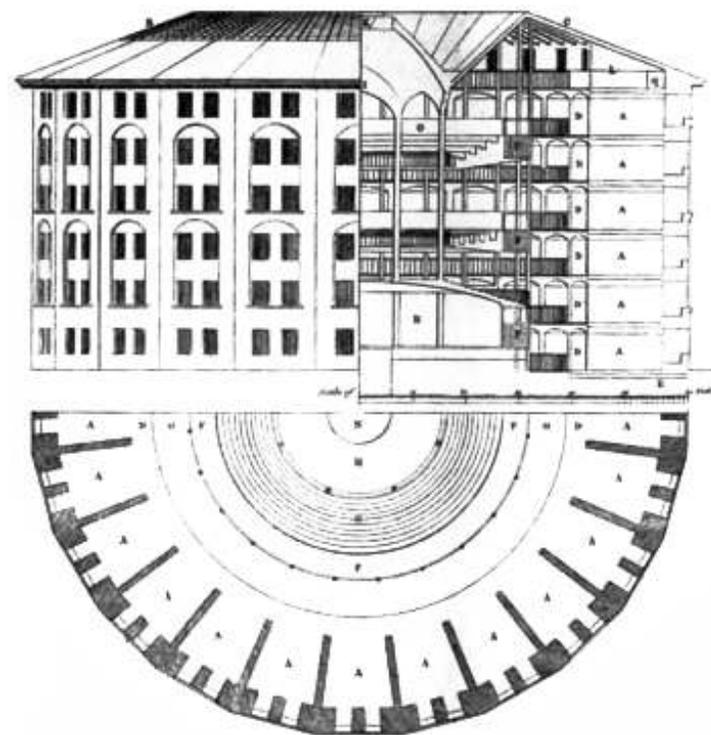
Fachada, Corte e planta baixa do Panóptico de Bentham.
